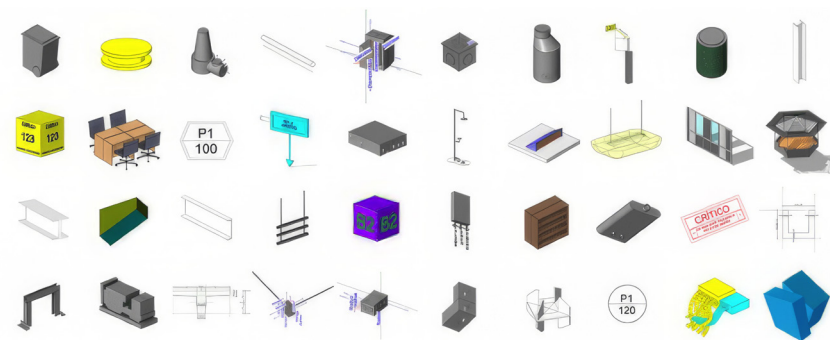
Familias Revit. (¿Qué Son Las Familias En Revit y Qué Tipos de Familia Existen? | Ip21, 2022)
